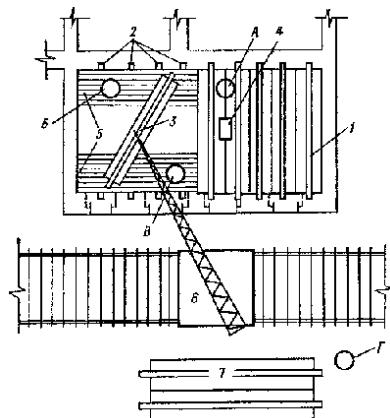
Схема организации работ на захватке по монтажу перекрытий из железобетонных балок-настилов с широкими нижними полками
